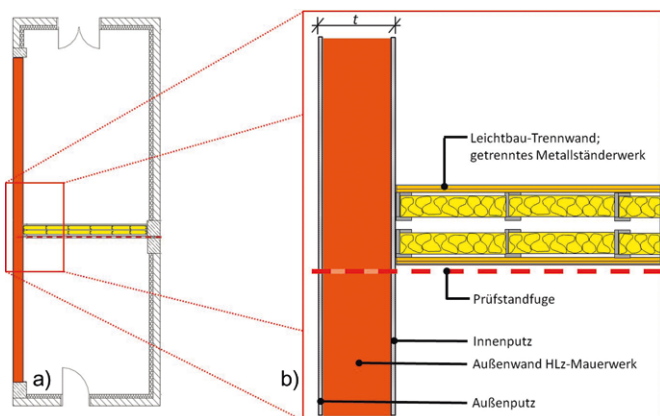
Horizontalschnitt zur Versuchsreihe mit durchlaufender HLz-AW; a) Grundriss, b) Detail
